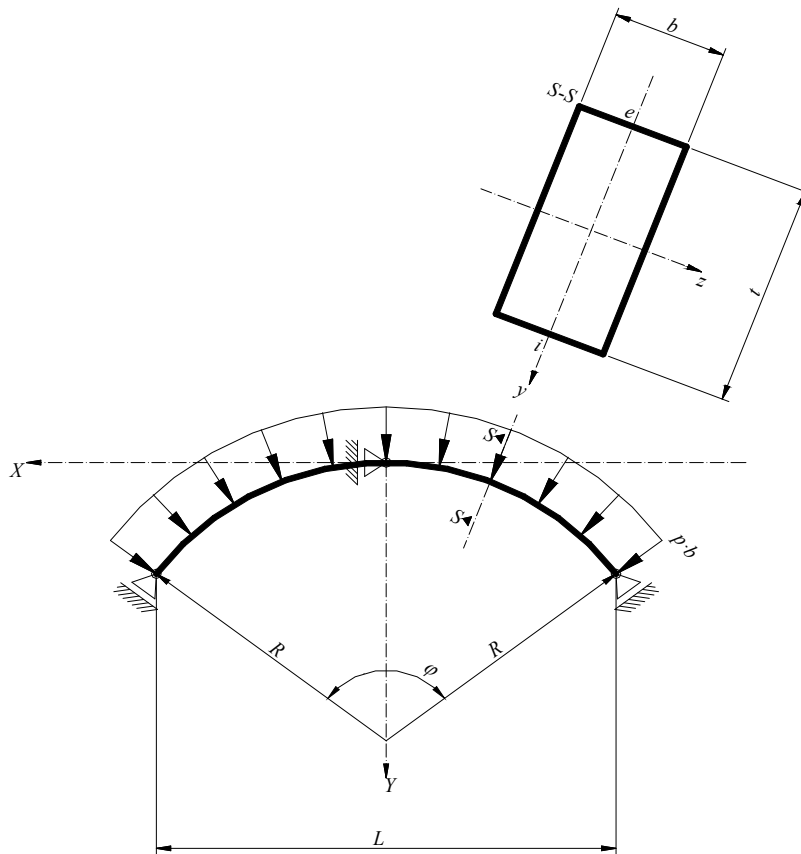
Vista em planta da geometria de um arco, de uma barragem de ângulo constante, e secção transversal do mesmo, com indicação dos parâmetros que intervêm na geração da geometria da barragem.
